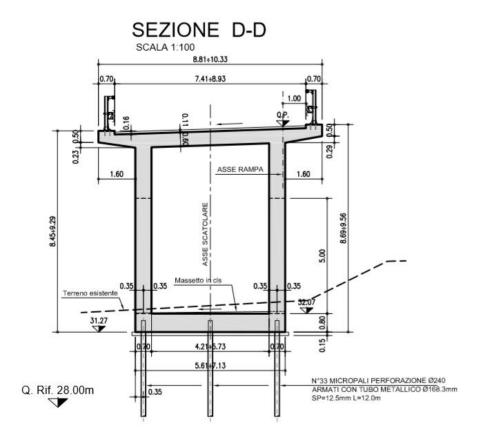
sezione trasversale nella mezzeria dello scatolare
